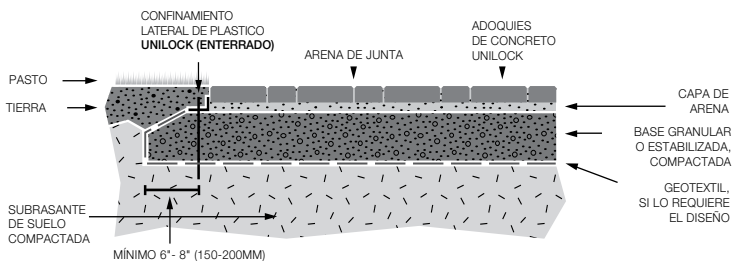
Instalación de adoquines de concreto con confinamiento lateral de PVC o de aluminio.
